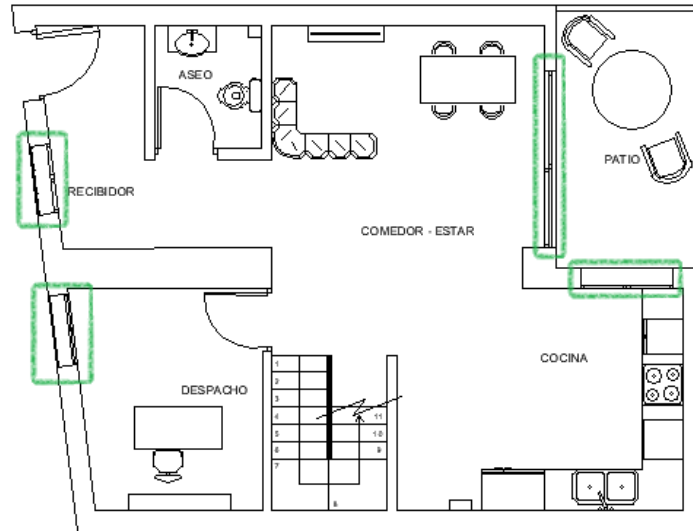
Croquis de nuevos huecos planta baja. Fuente propia
